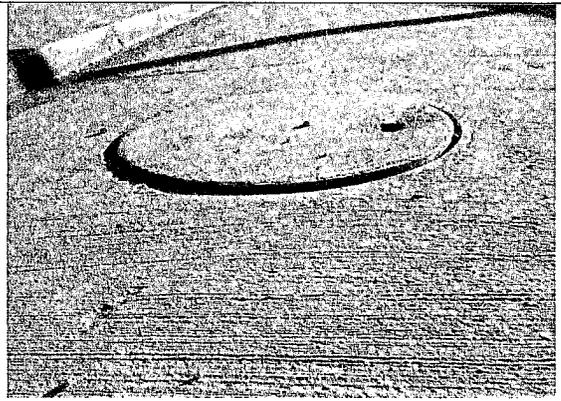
TAPA CÁMARA A DESNIVEL
